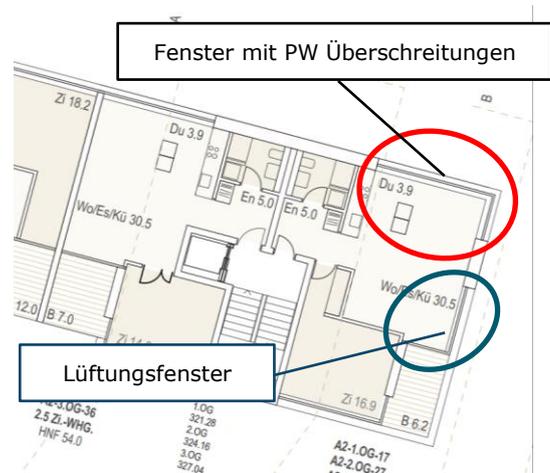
Grundriss 1.-3. OG Gebäude A2
